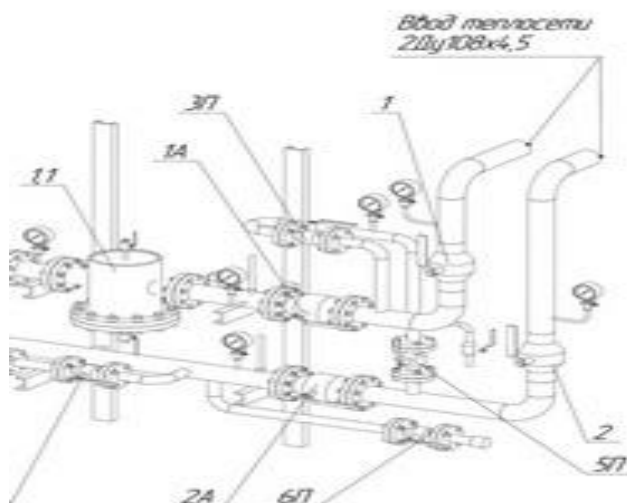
Схема тепловых сетей отдельно стоящей котельной №8 (ул. Веры Ершовой, 16)
